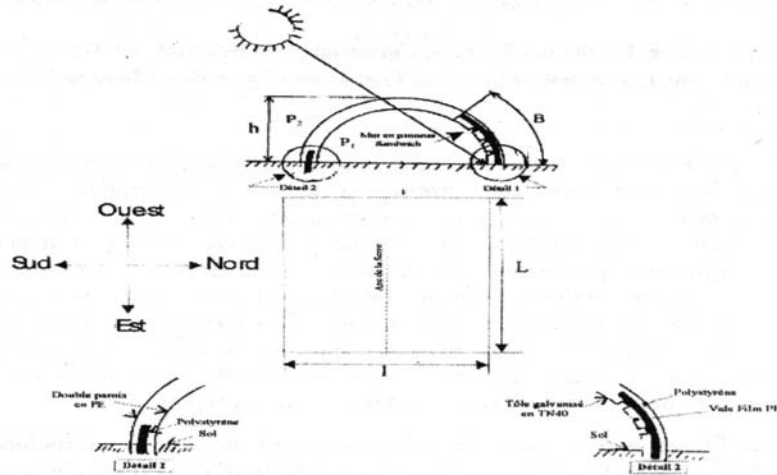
Serre à double paroi constituée dans sa face nord d'un mur en panneaux sandwich
